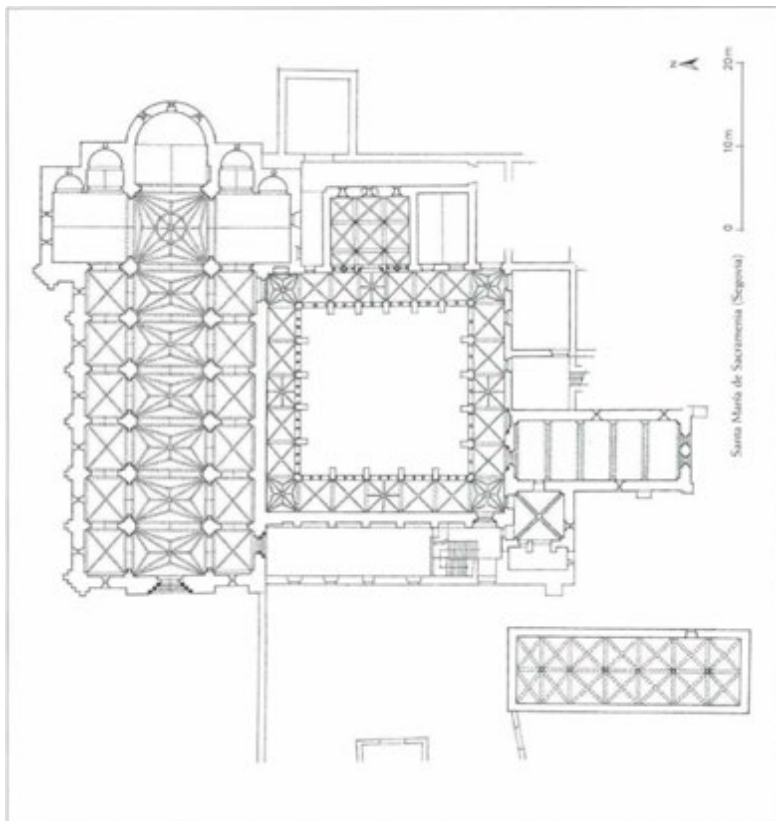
Sacramenia, Santa María, Grundriss Kirche und Kloster, nach Torres Balbás/Merino de Cáceres, 1998.
